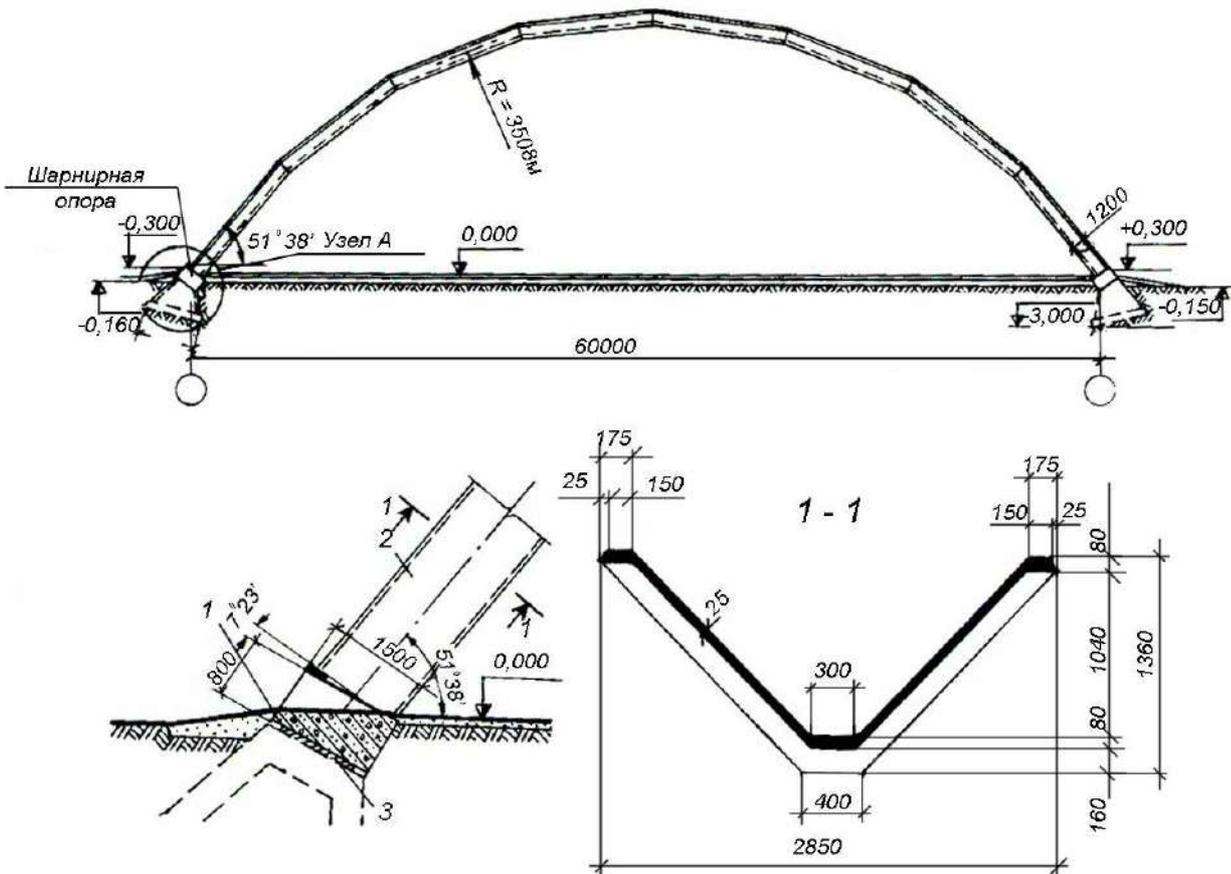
Складка из плоских сборных железобетонных элементов:
